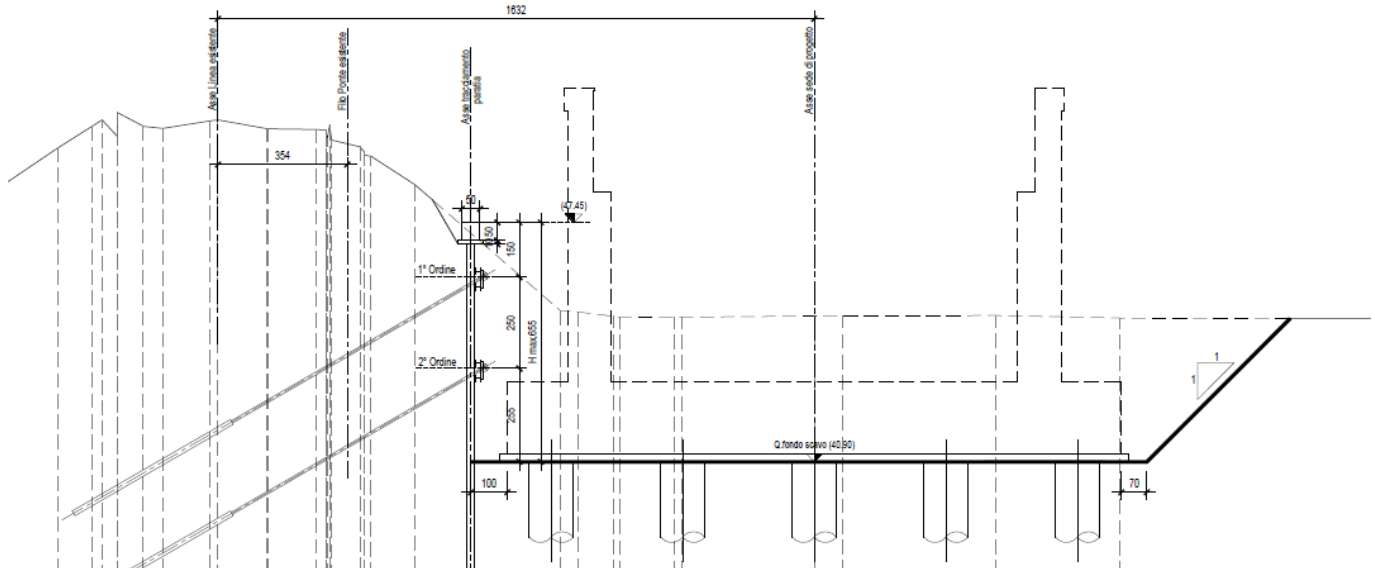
VI07 - SEZIONE SCAVI DI PD
